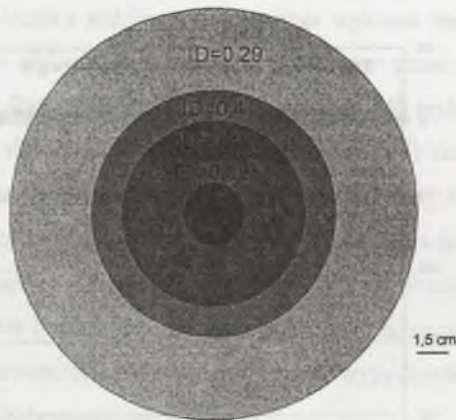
Schemat pionowego przekroju pojedynczej kolumny wykonany na podstawie odkrywek
